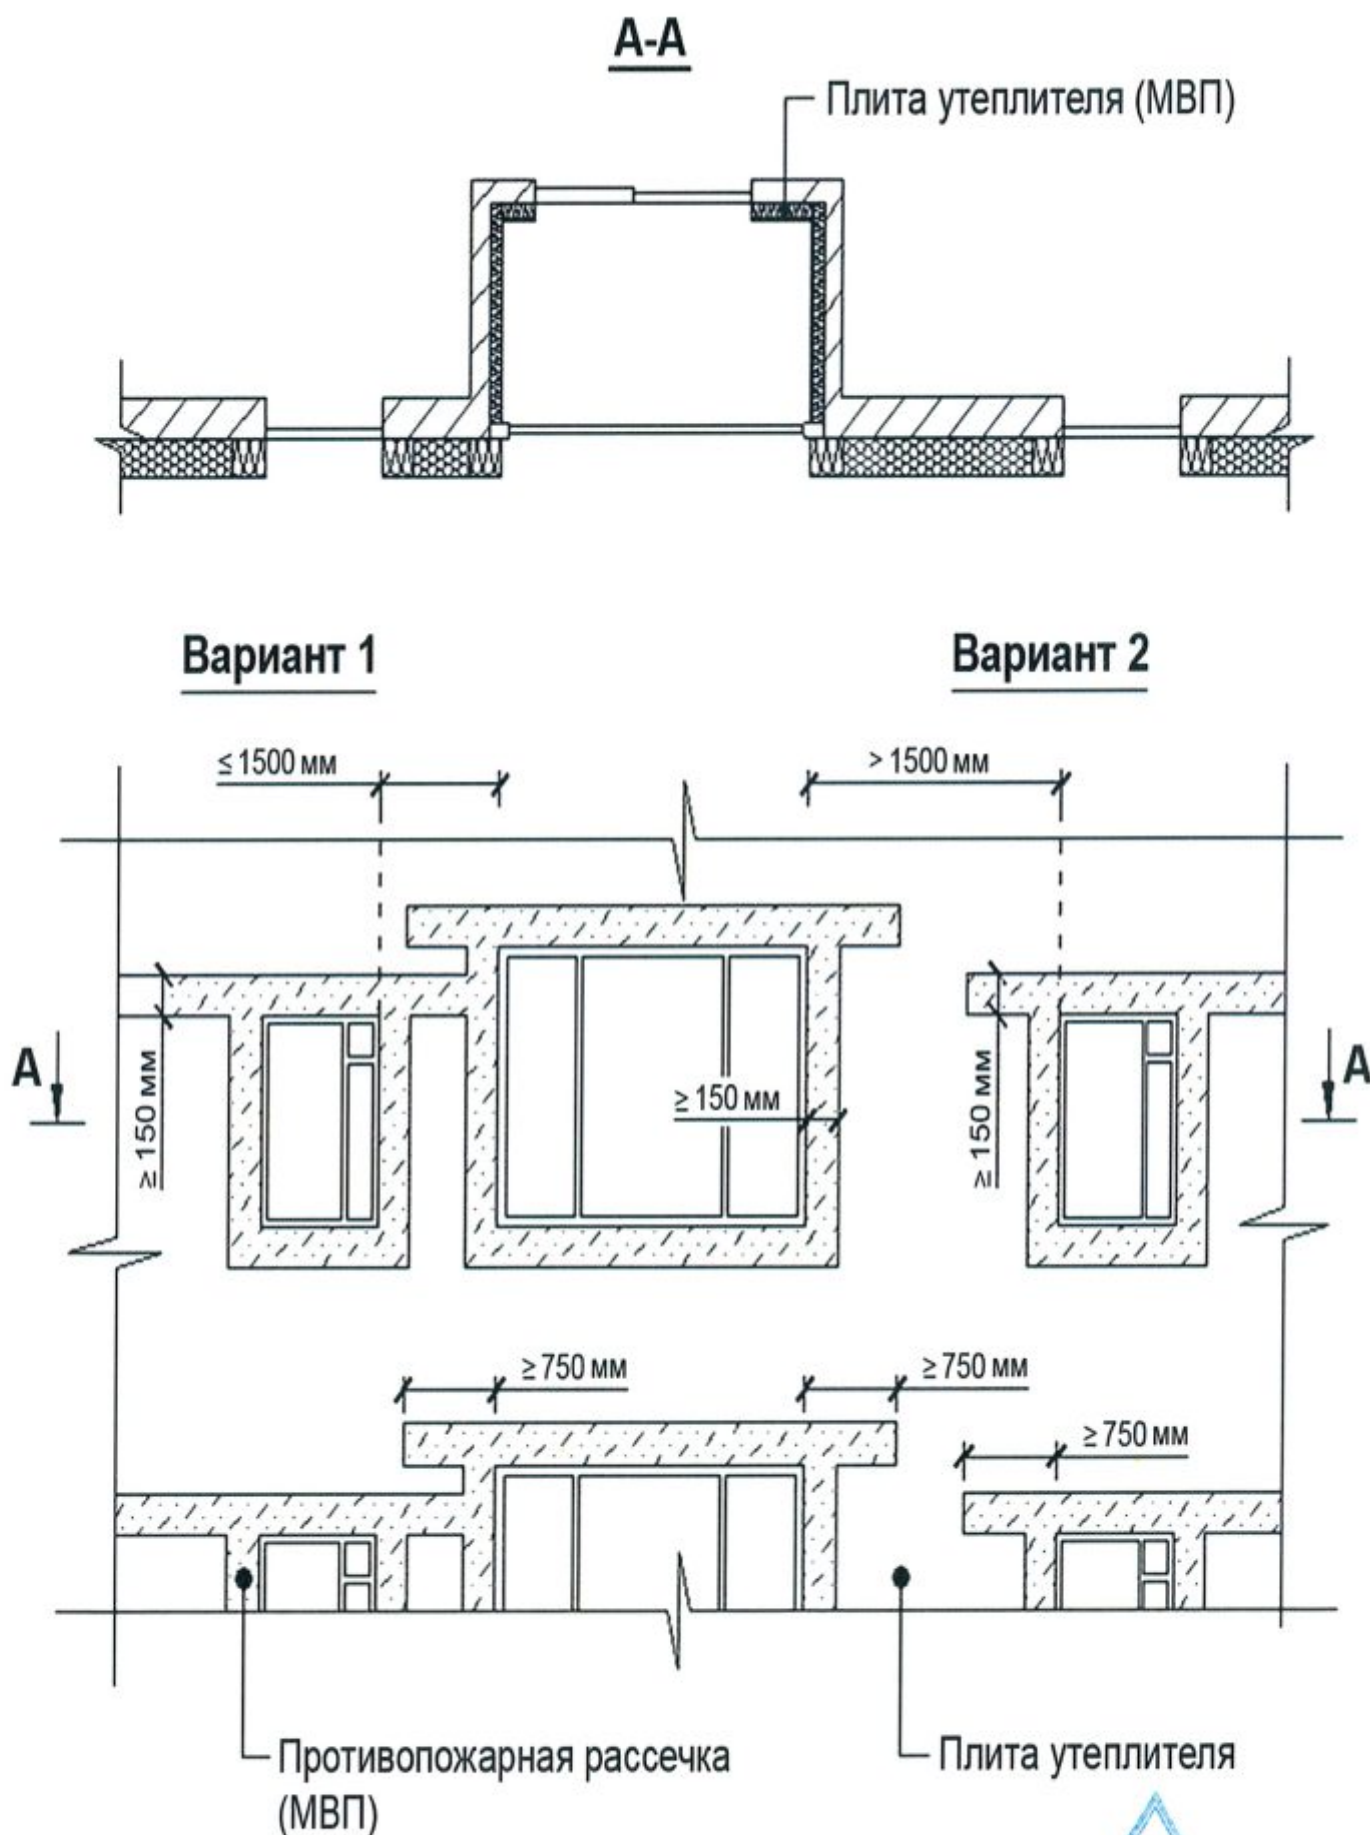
Участки наружных стен по периметру остекленных лоджий
